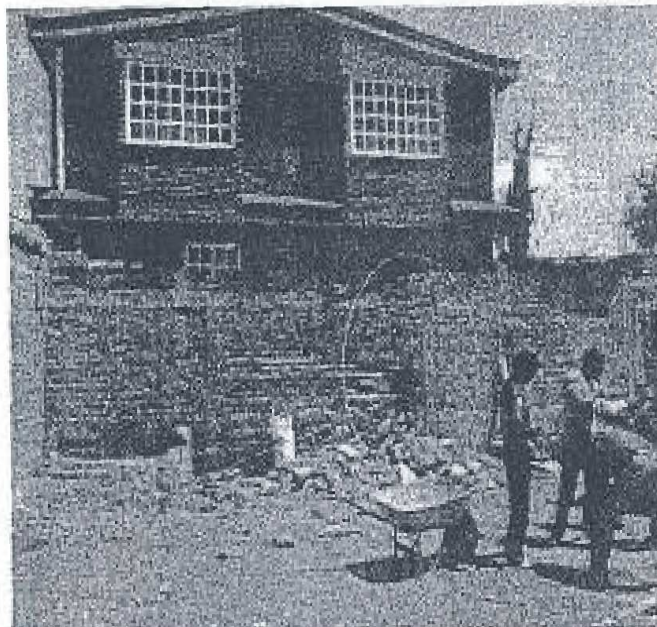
Predio en donde permanece la barda de colindancia, la construcción fue demolida.
